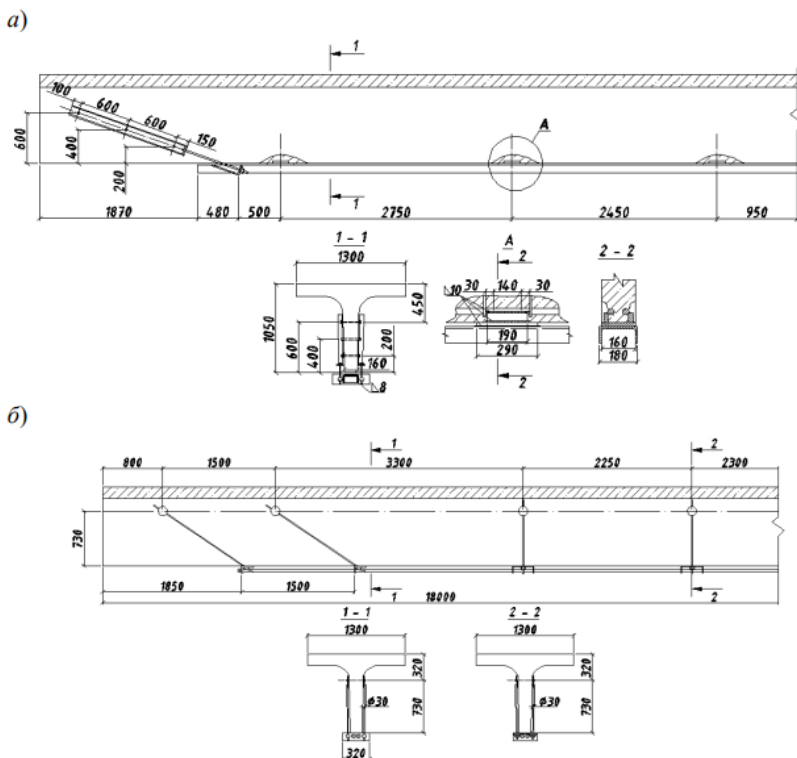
Конструкция усиления главных балок пролетных строений металлом: а) приварка или приклейка швеллера; б) постановка дополнительных стержней рабочей арматуры
